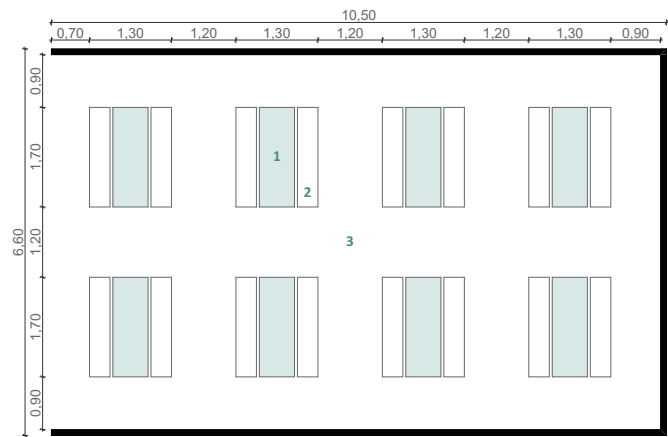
Planta de comedor. Fuente: Autores.
